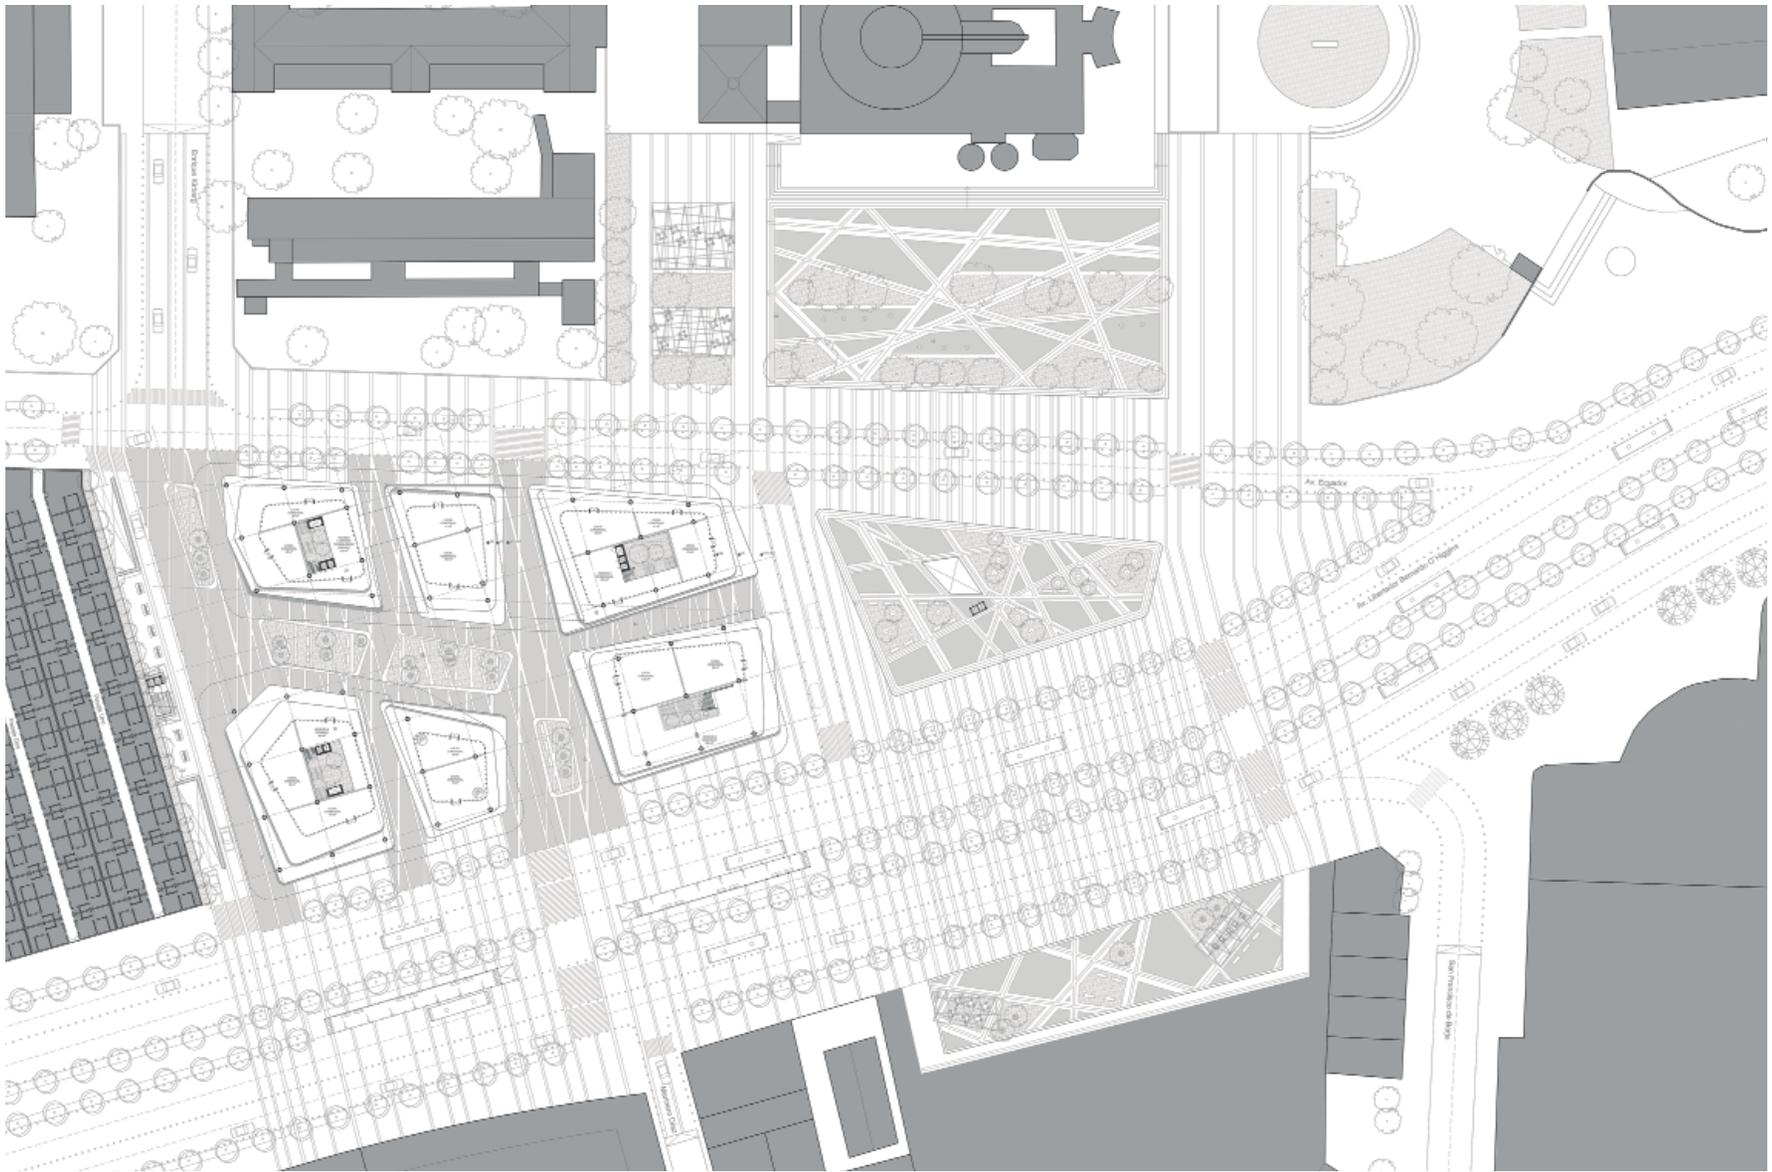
Planta de Inserción Urbana. Fuente: Elaboración Propia.
